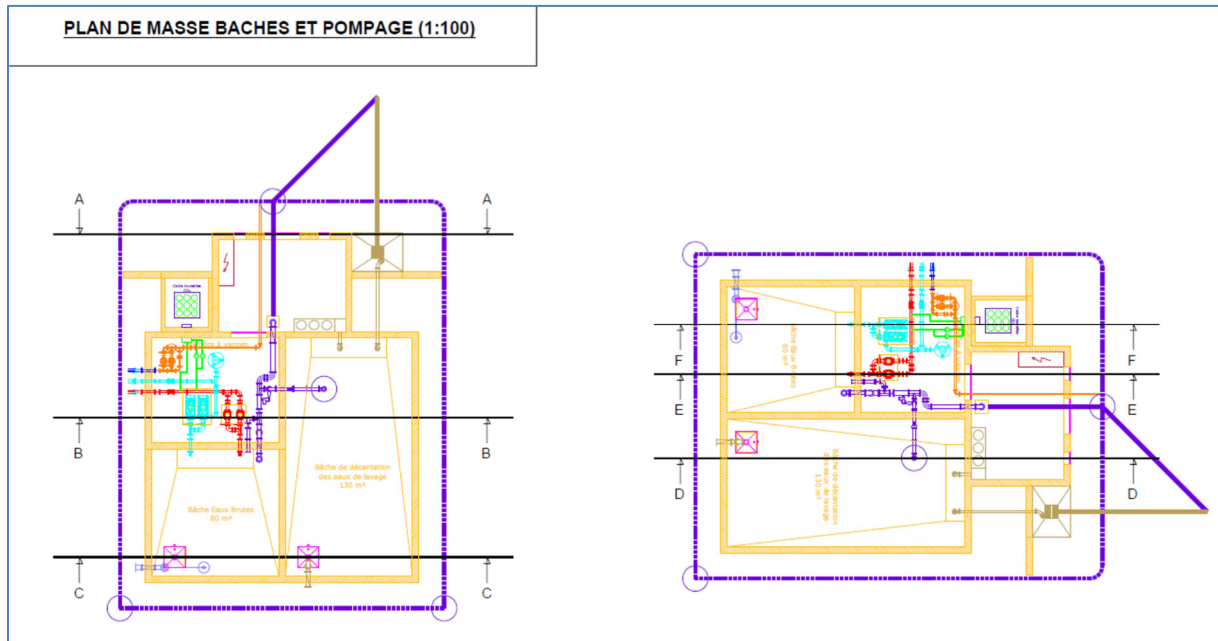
Plan des baches et du local de pompage (vue en plan)
